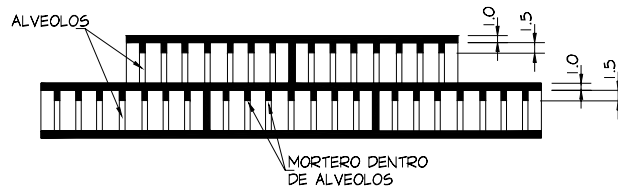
Detalle de penetración del mortero en los alvéolos
